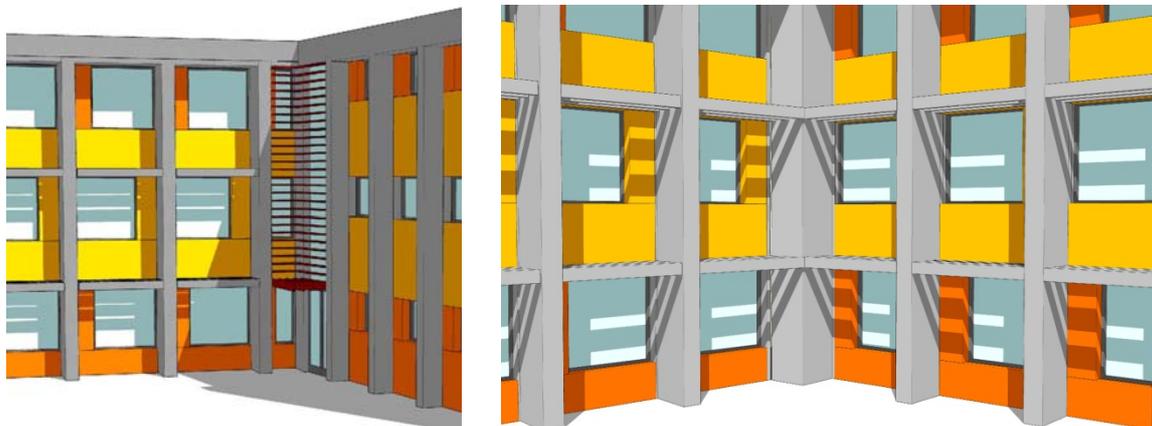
Fassadenausschnitt Kreuzbau: quadratische Fenster mit horizontalem Sonnenschutz
